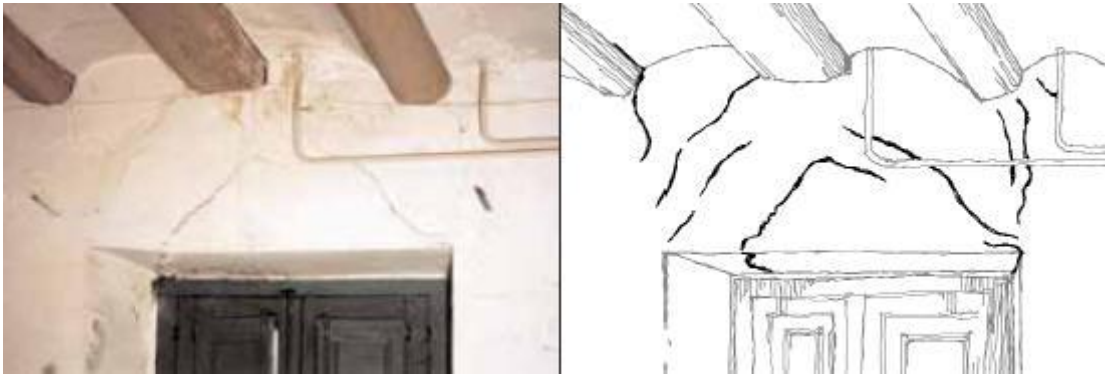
Fissures dues à la déformabilité des poutres constituant le plancher
